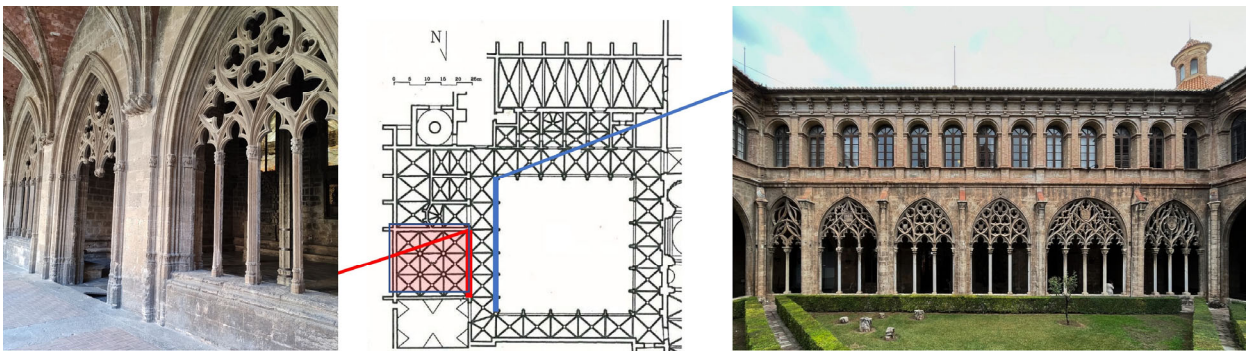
Zona claustral, localización en planta de la panda este y aula capítular. Figure 2. Cloister area, location in plan of the east wing and chapter house.
